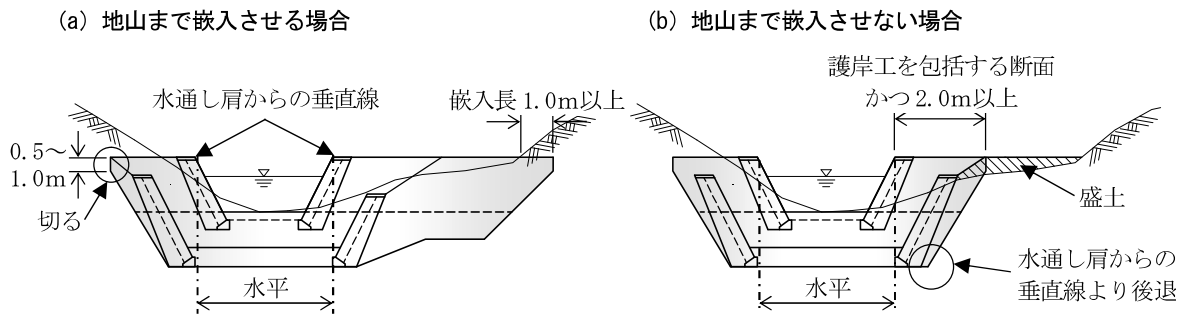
溪流保全工内床固工の袖部の嵌入長と形状例
